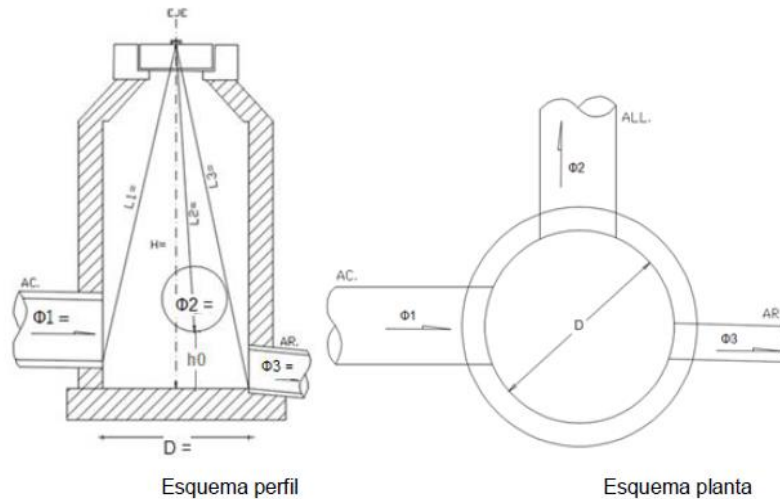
Vista en altura y planta del levantamiento de un aliviadero de orificio.
